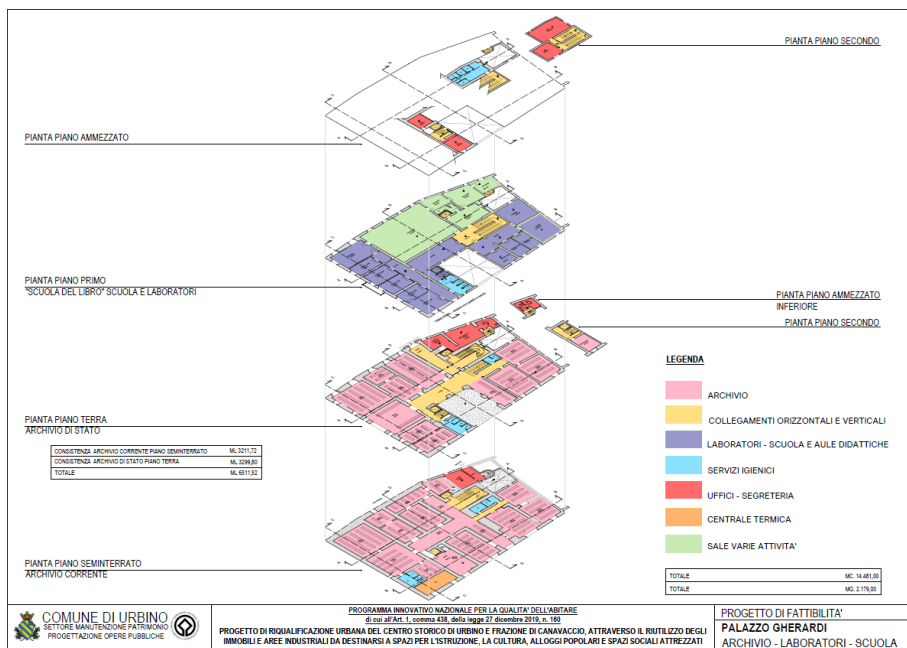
Planimetria dell'interno dell'edificio storico: Gherardi (Sub.Archivio-Sub.Laboratori-Sub.Scuola)
